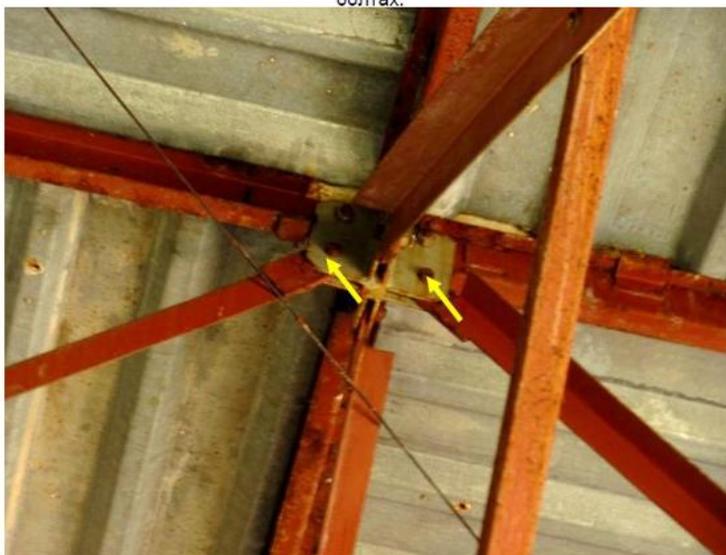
Стик розкосів діагональних ферм до верхнього поясу з допомогою накладок на болтах.
